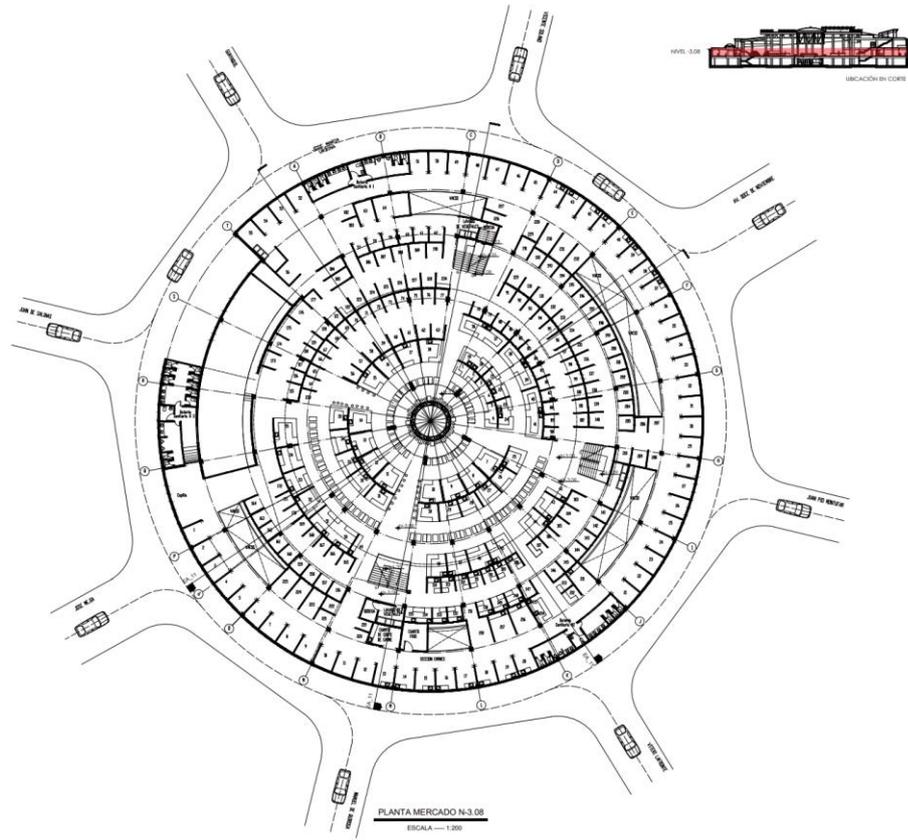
27: Planta nivel – 3.08 de la Plaza Cívica Mercado Urbina
